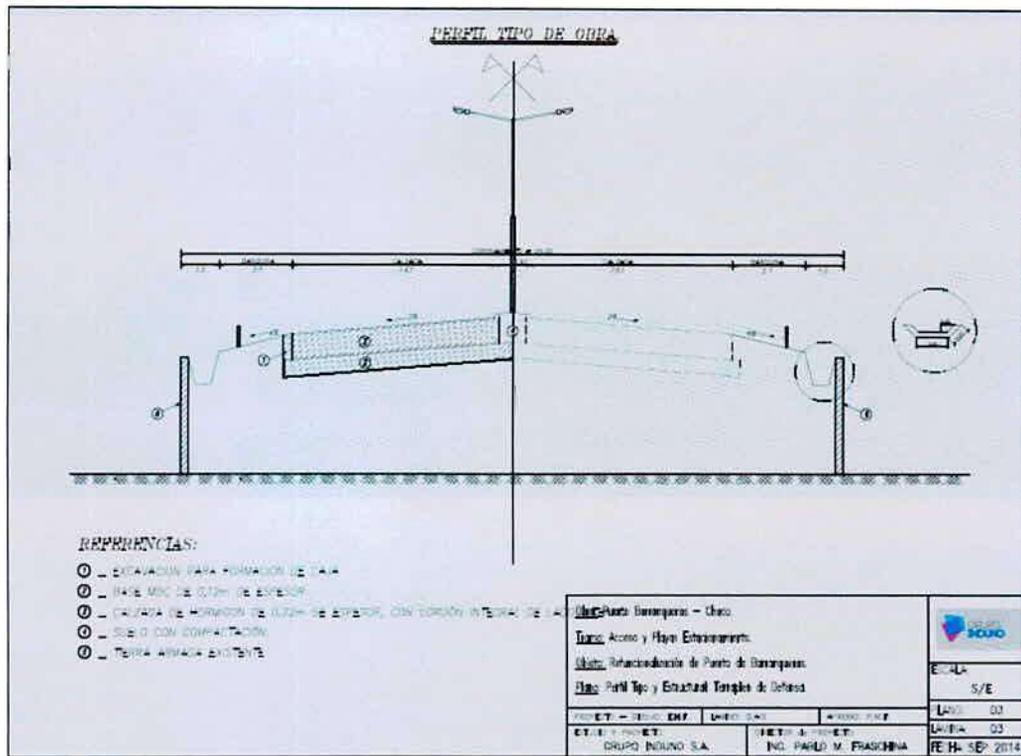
Perfil tipo de obra: Obra nueva sobre terraplén de defensa secc. 3 - fuente: Proyecto Ing
